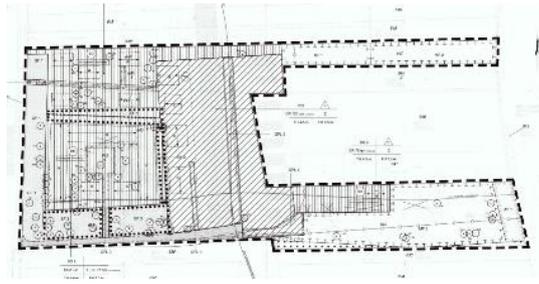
B-Plan Nr. 5<sup>25</sup>
